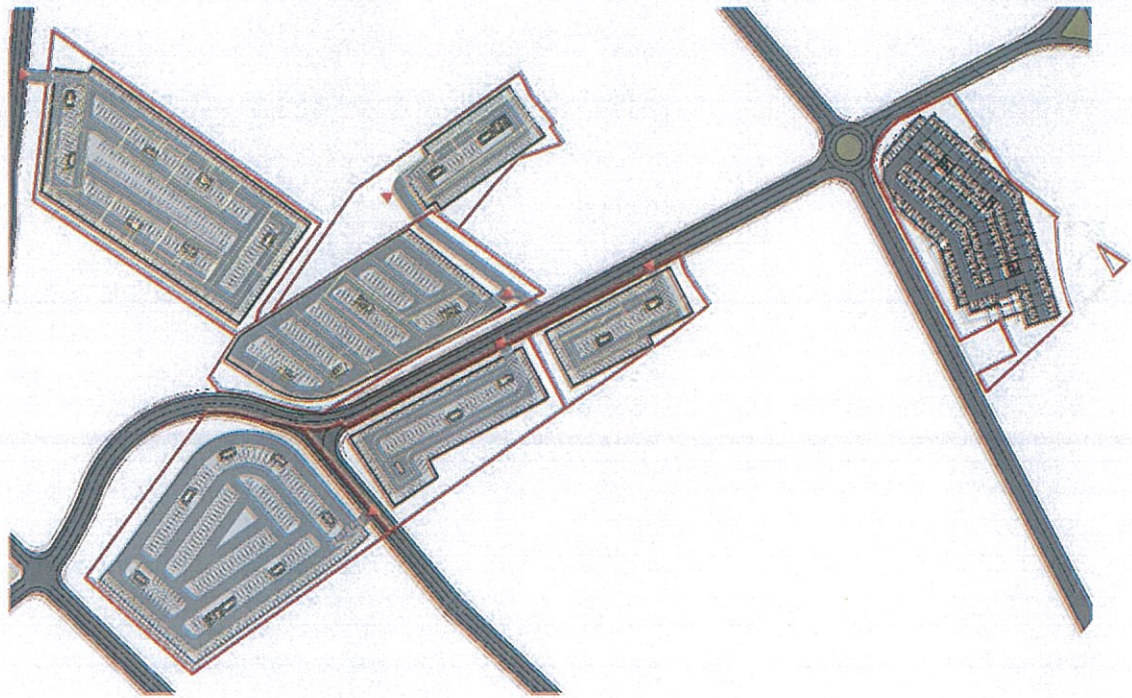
Planimetria e katit nëntokë, të parkimeve
